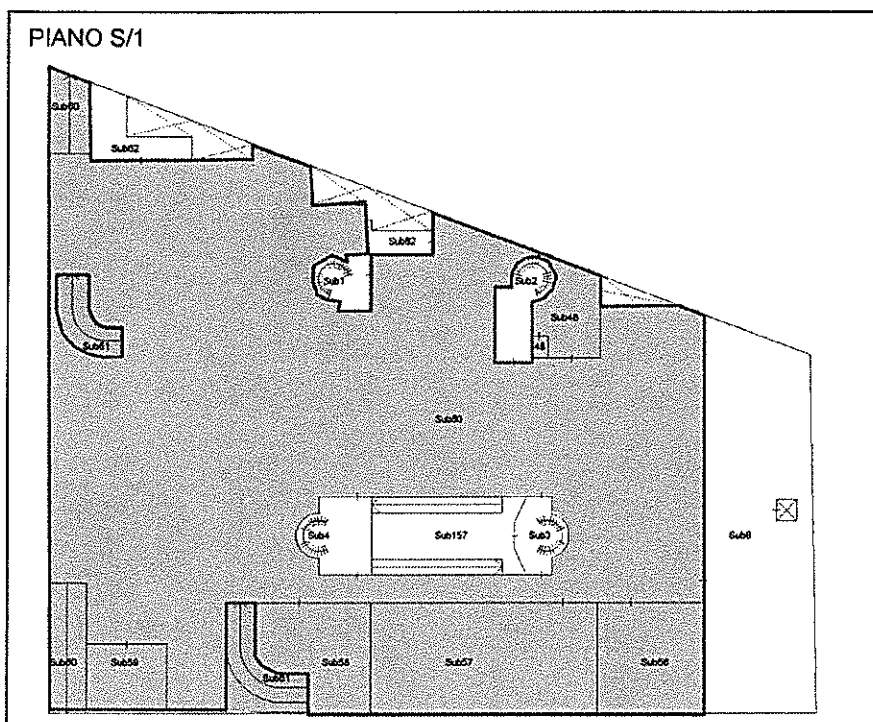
Elaborato planimetrico piano S1. Individuazione sub 48 (porzione), 56, 57, 58, 59 e 60 e 61 (ora 162).
